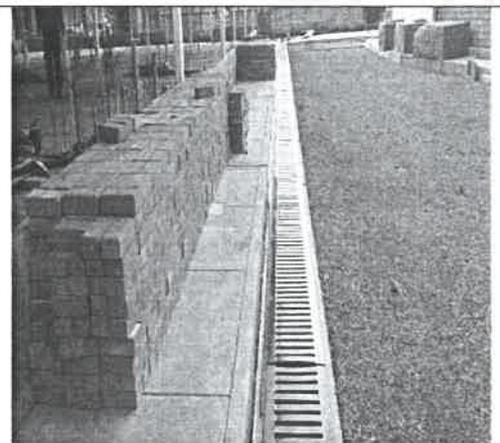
La vista muestra cangrejas del muro de contención perimetral.
